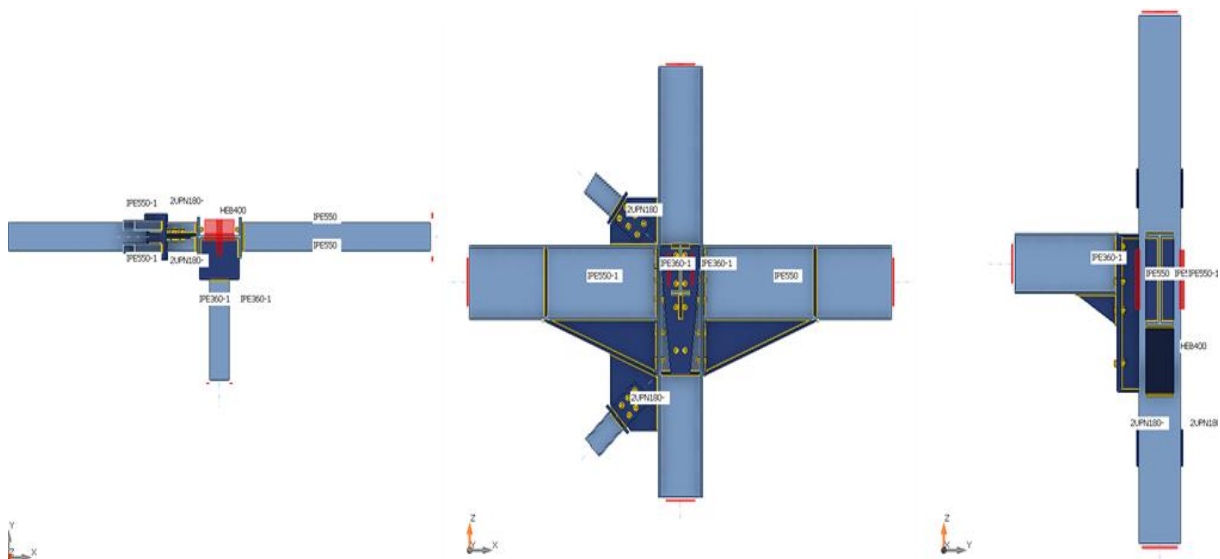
Vue des trois plans orthogonaux de Type 03.
